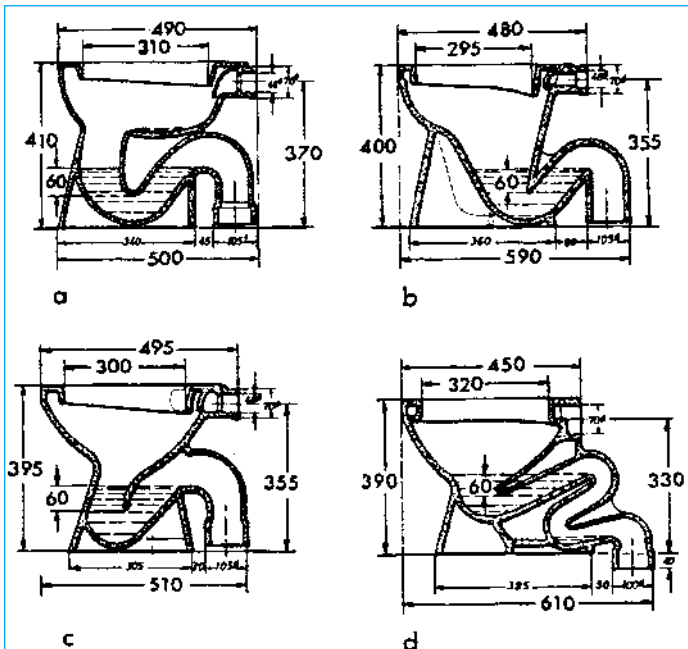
Bodenstehende Wasserspülklosetts mit angeformtem Geruchverschluss – a) Flach- oder Ausspülklosett, b) Tiefspülklosett, c) Zungenklosett, d) Absaugklosett
